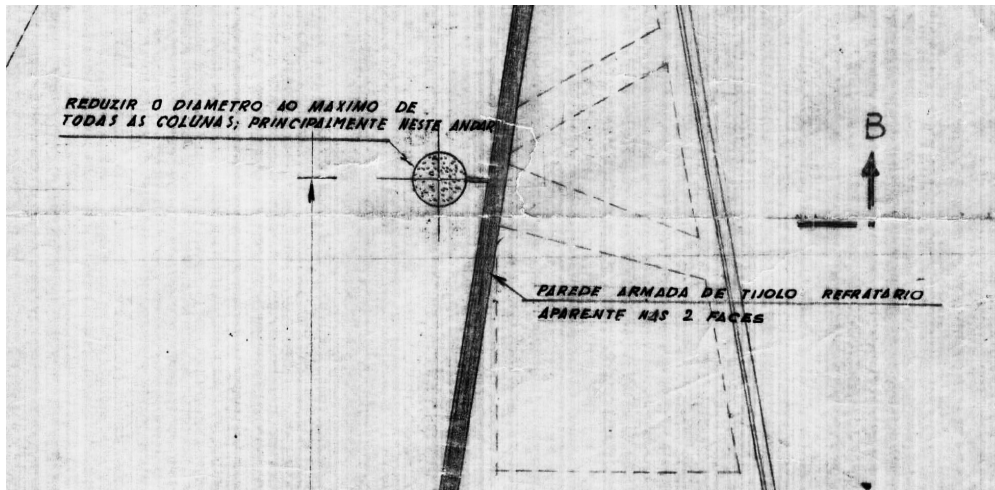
Projeto executivo original - Detalhe da parede de tijolos do 3º pavimento
